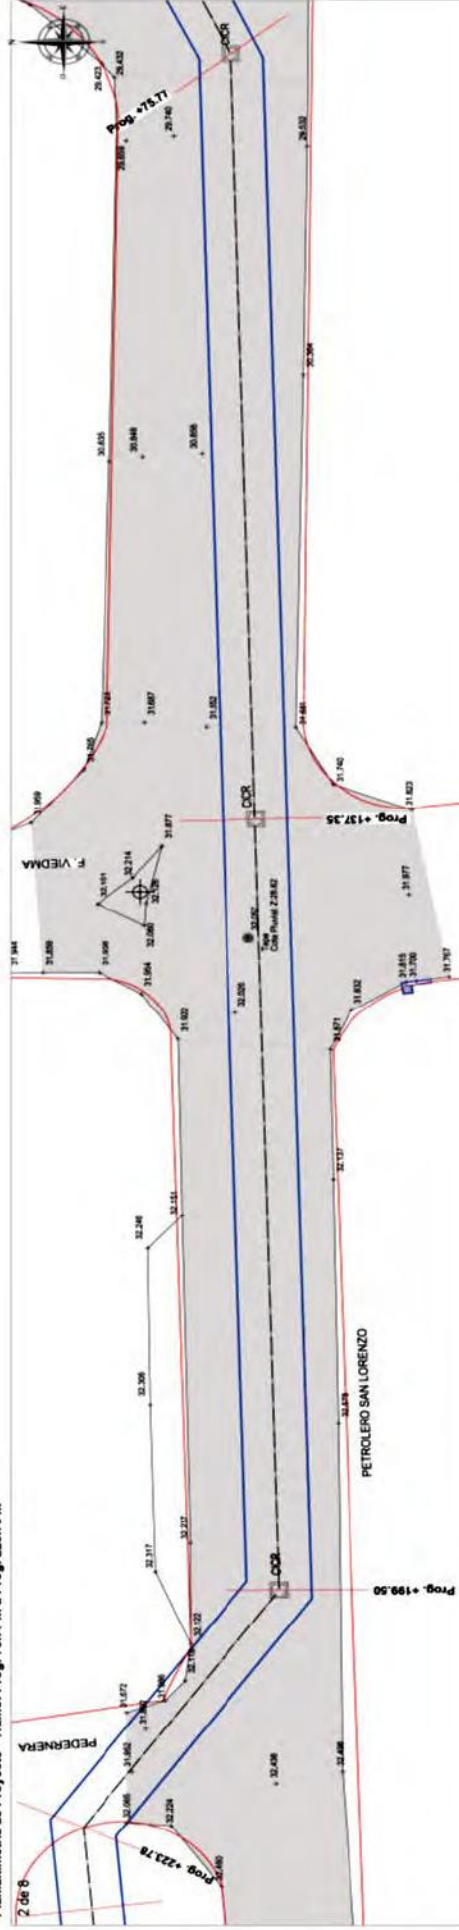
Planialtimetría de proyecto Tramo Progresiva 75.77 m. a 223.76 m.
